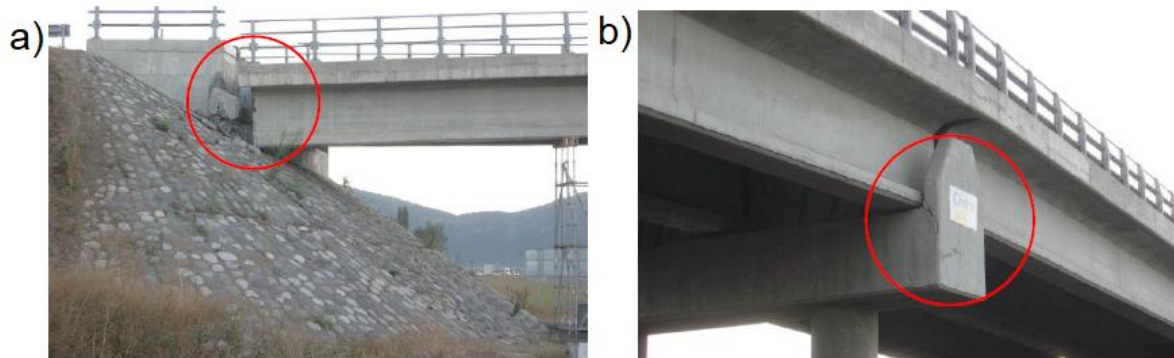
a) Fallo en tapa en los estribos y b) Grietas en tapas en cepas centrales [9].
